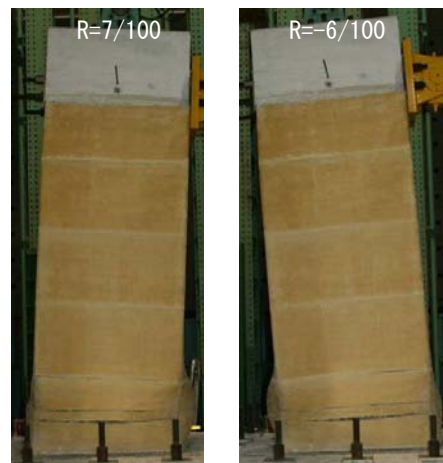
試験体の損傷状況 (試験体 No. 2)
